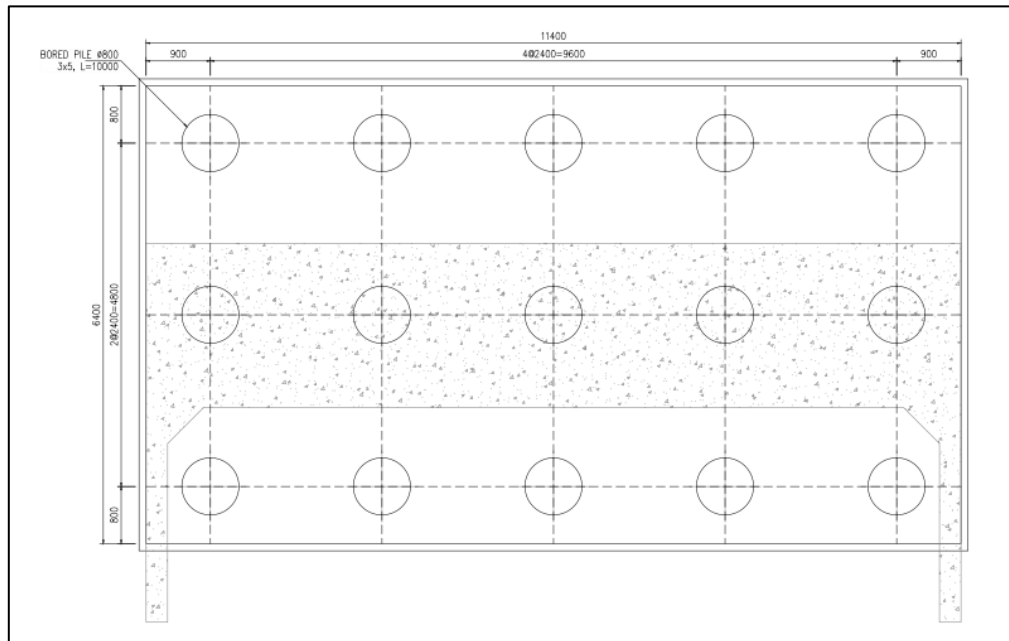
Potongan Melintang Jembatan Abutment 2
